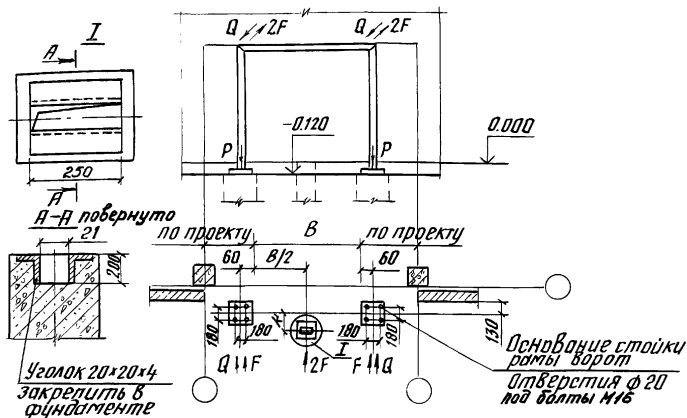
Схема расположения ворот и нагрузки от них на элементы здания
